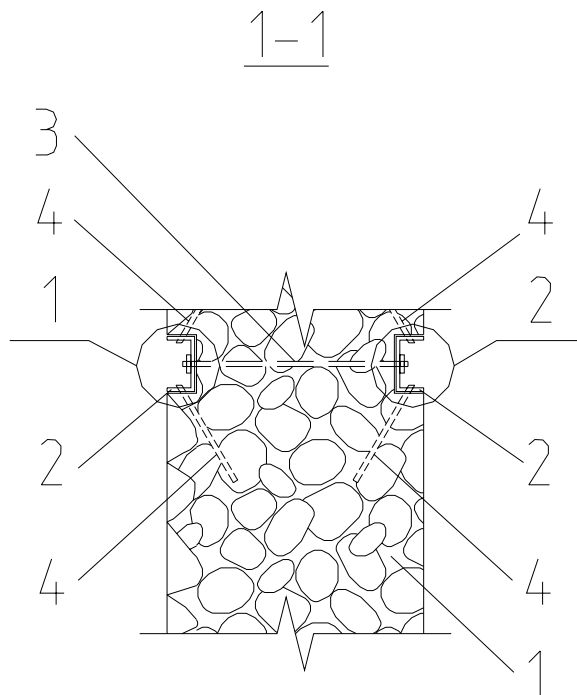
Розріз 1-1 до фрагменту плану будинку, що підлягає посиленню
